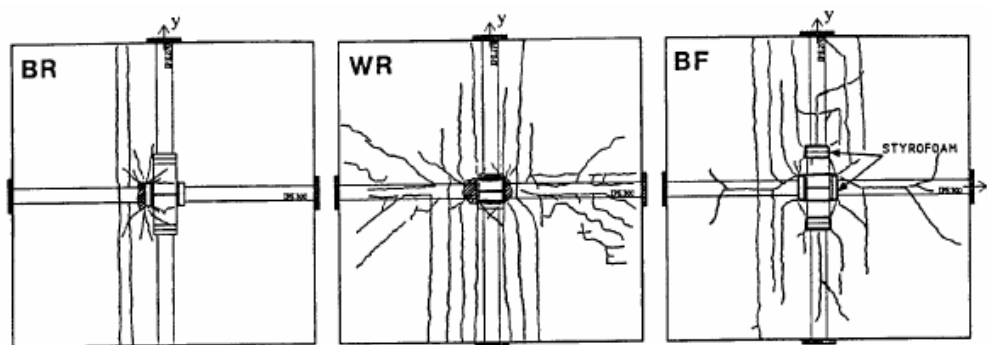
Modelul fisurilor din plăcile de beton
